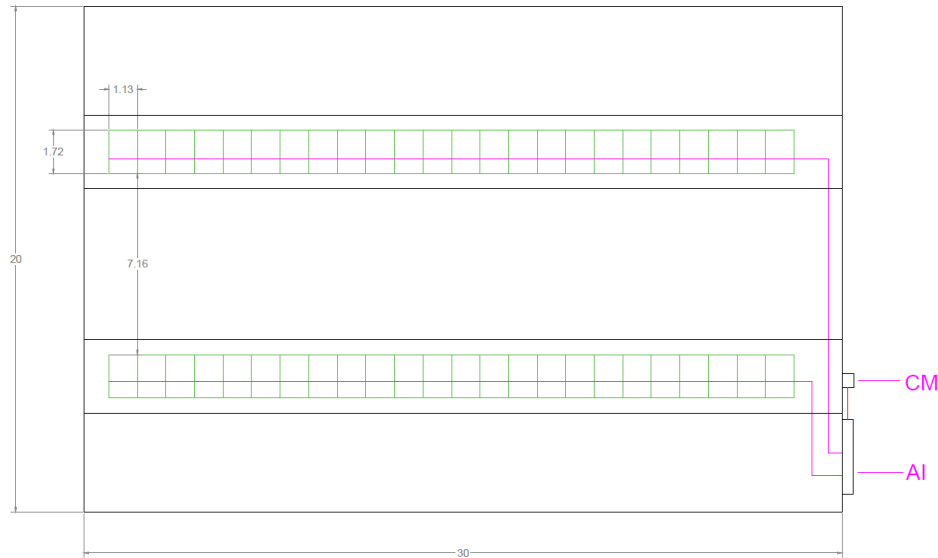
Distribución de los módulos en la cubierta de la almazara. Fuente: elaboración propia
